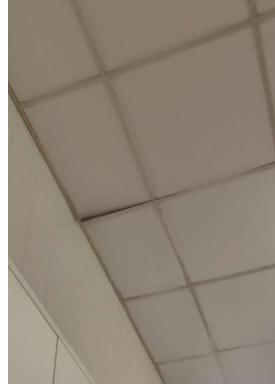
Teto da Planta Piloto de Produtos Lácteos
